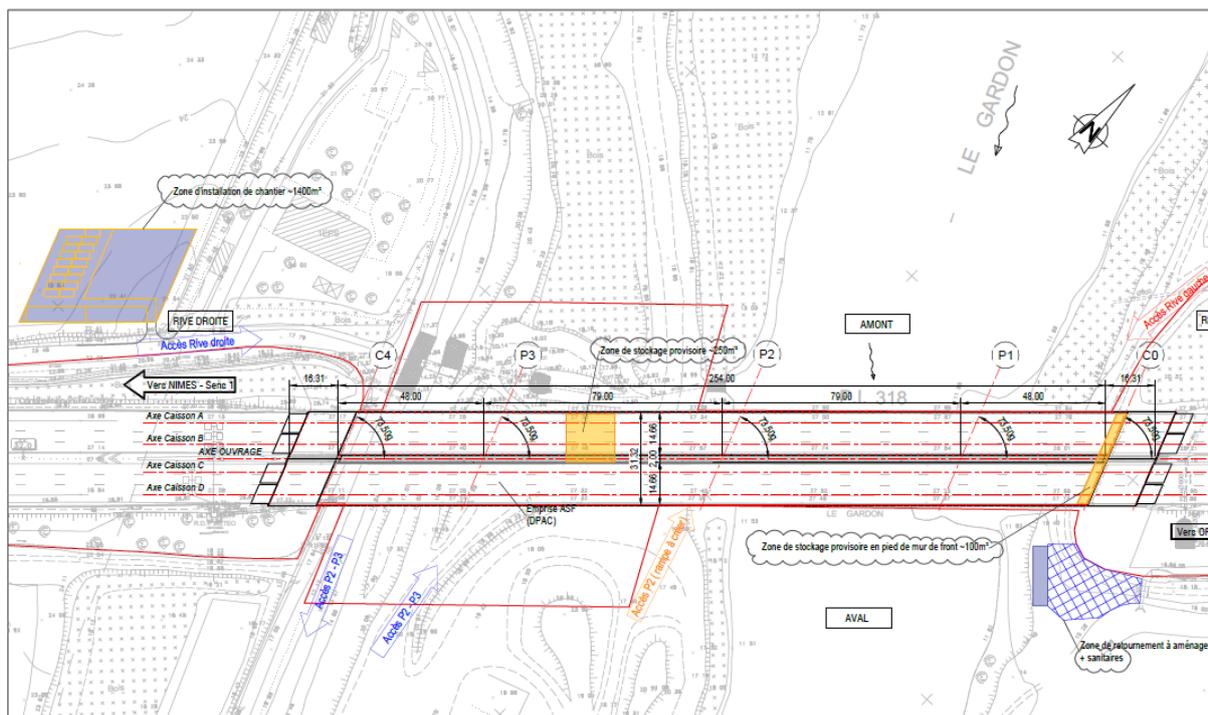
Vue en plan général des accès et installations (Arcadis, 2021)
